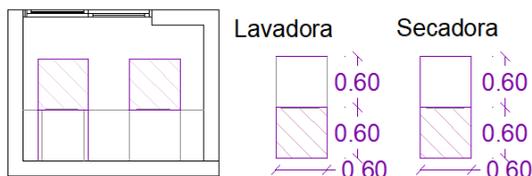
Dimensiones y ocupación en planta de figuras inscritas de uso y de zona de aparato en zona de lavado de la vivienda
